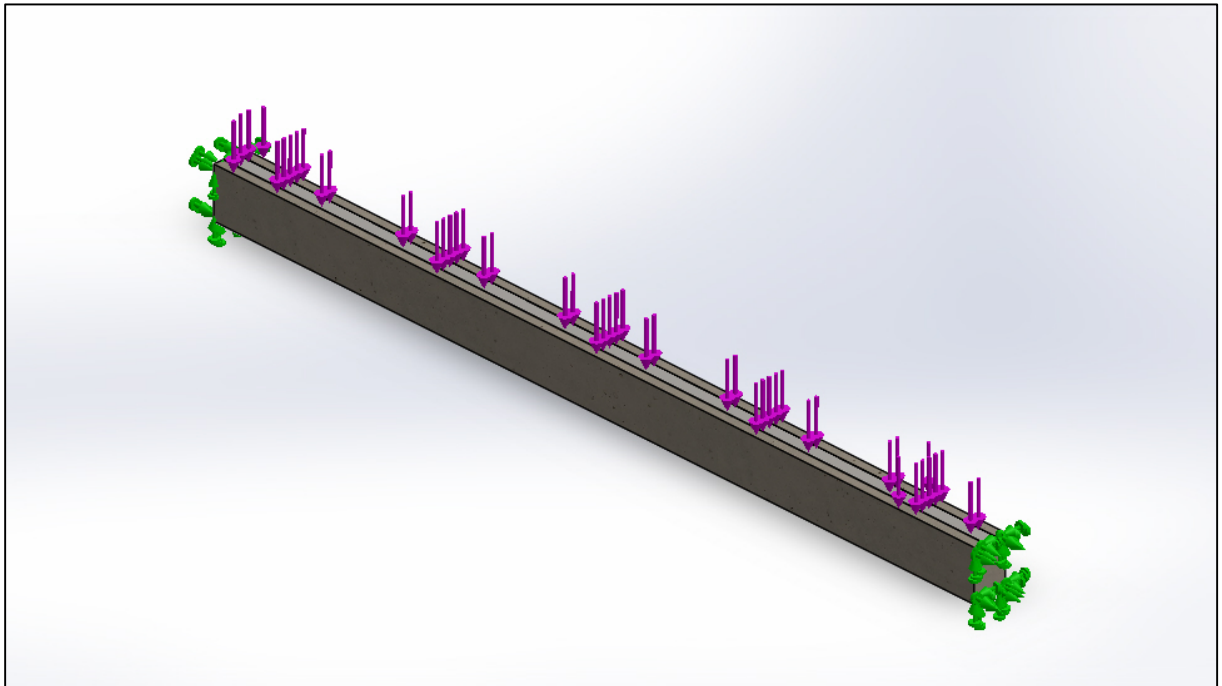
Visualização das condições de apoio e cargas para a viga de betão com a aplicação do reforço 1.
